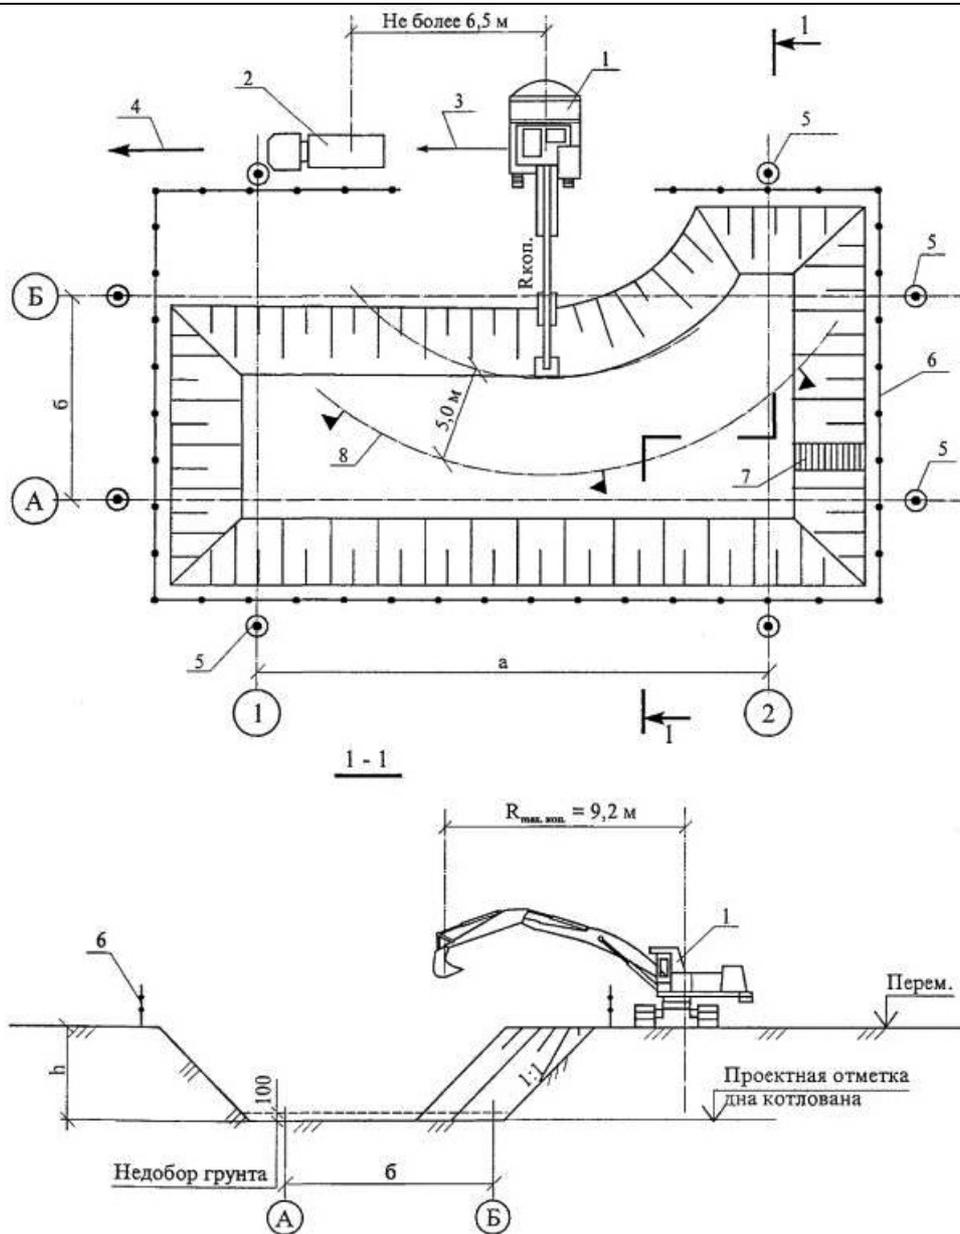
Схема разработки грунта котлована экскаватором, оборудованным ковшом обратная лопата при боковой открытой проходке
